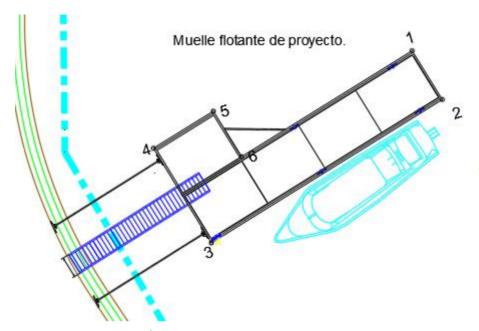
UBICACIÓN DE PONTONES, UNIDOS POR VIGAS DE MADERA DE PINO.
